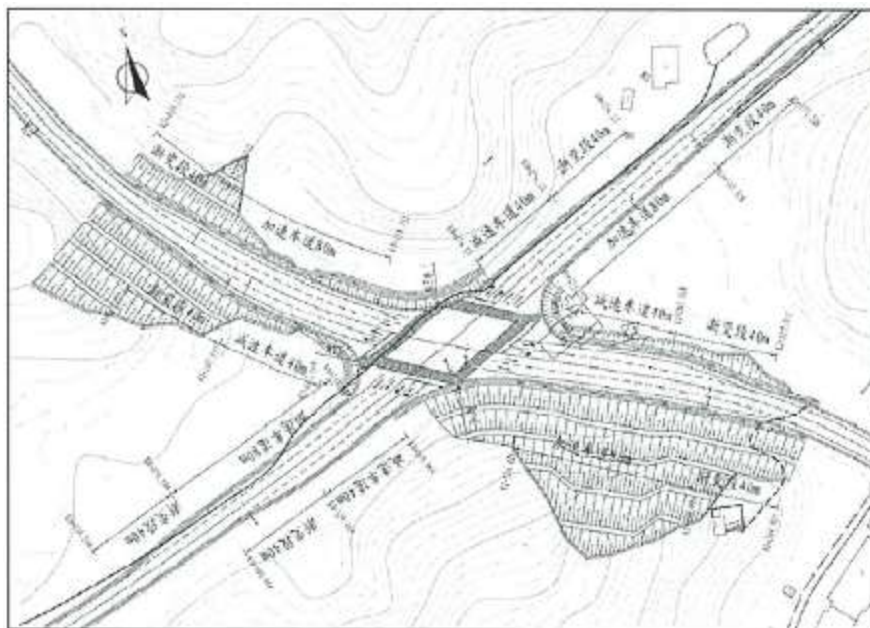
东梅连接线 K2+191.501 交叉口平面图
